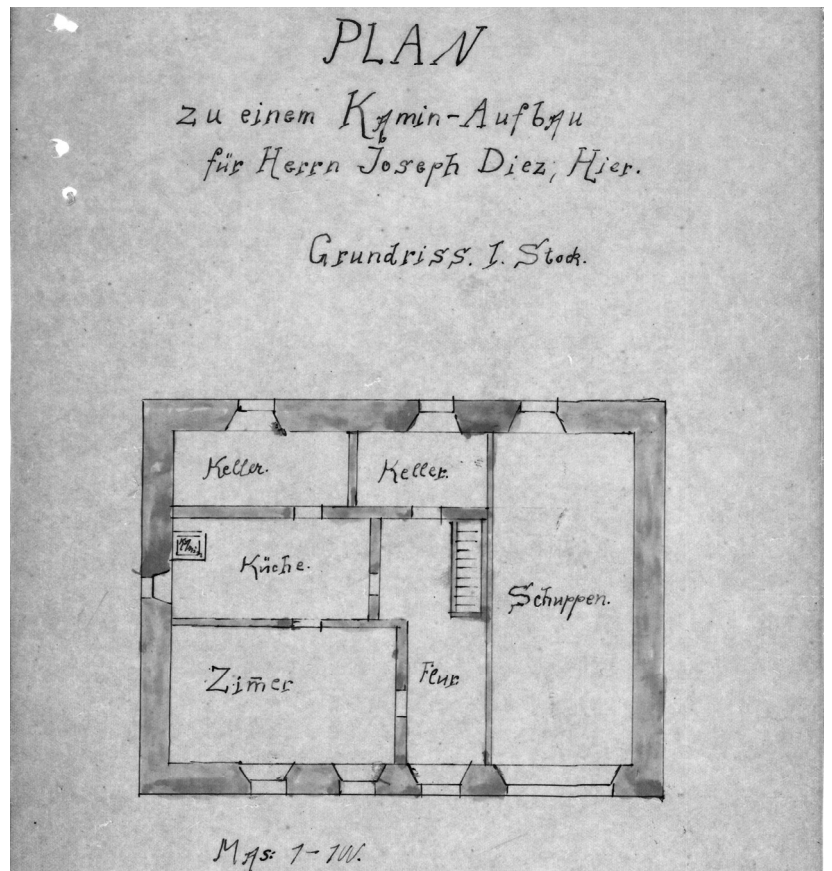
Järgasse 10, Haupthaus, Grundriss Erdgeschoss, Plan von 1907.
